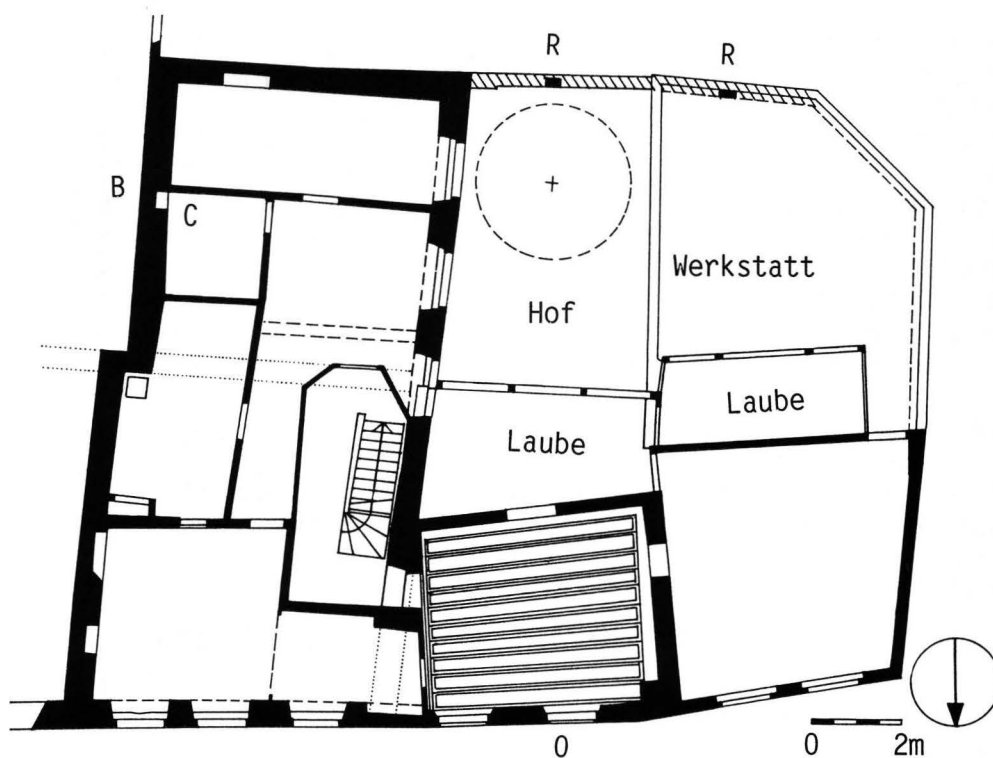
Stiftsgasse 5. Grundriss von Haupt- und Flügelgebäude im 1. Obergeschoss. – Zeichnung: St. Tramèr.
